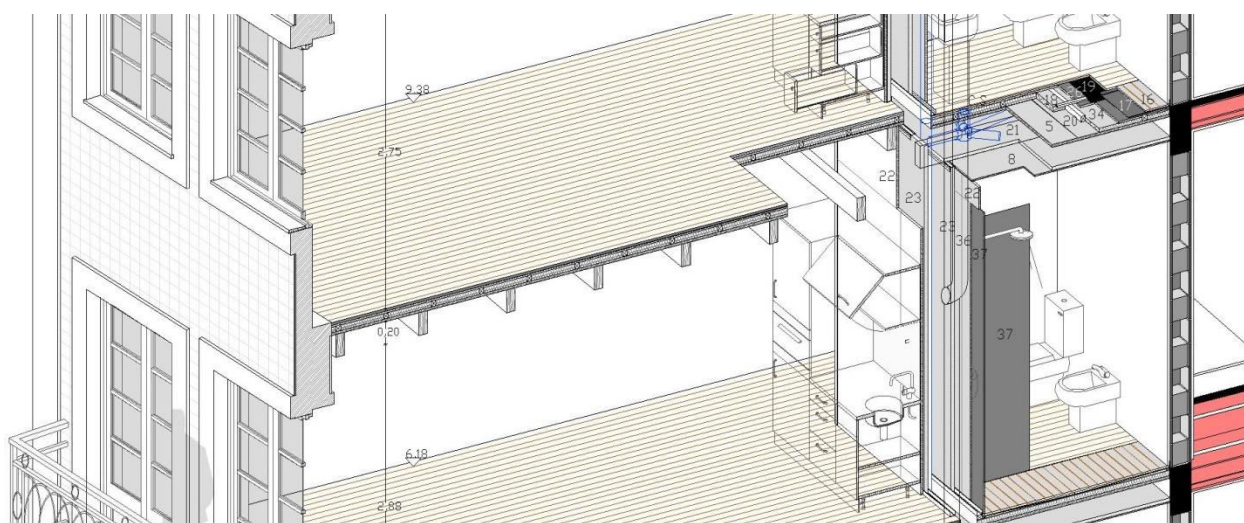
Corte perspectivado e caracterização construtiva da laje da casa de banho
